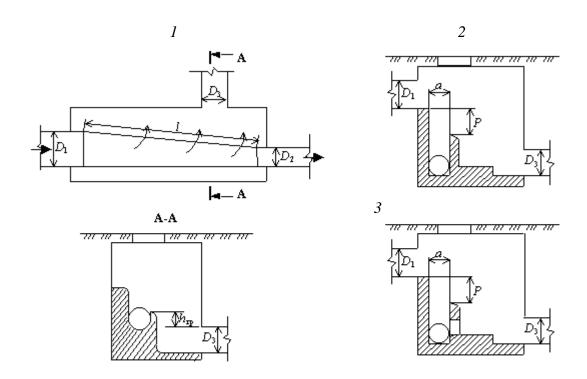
Некоторые типы разделительных камер 1 – с прямолинейным водосливом; 2 – с разделительной стенкой; 3 – то же, с отверстием
